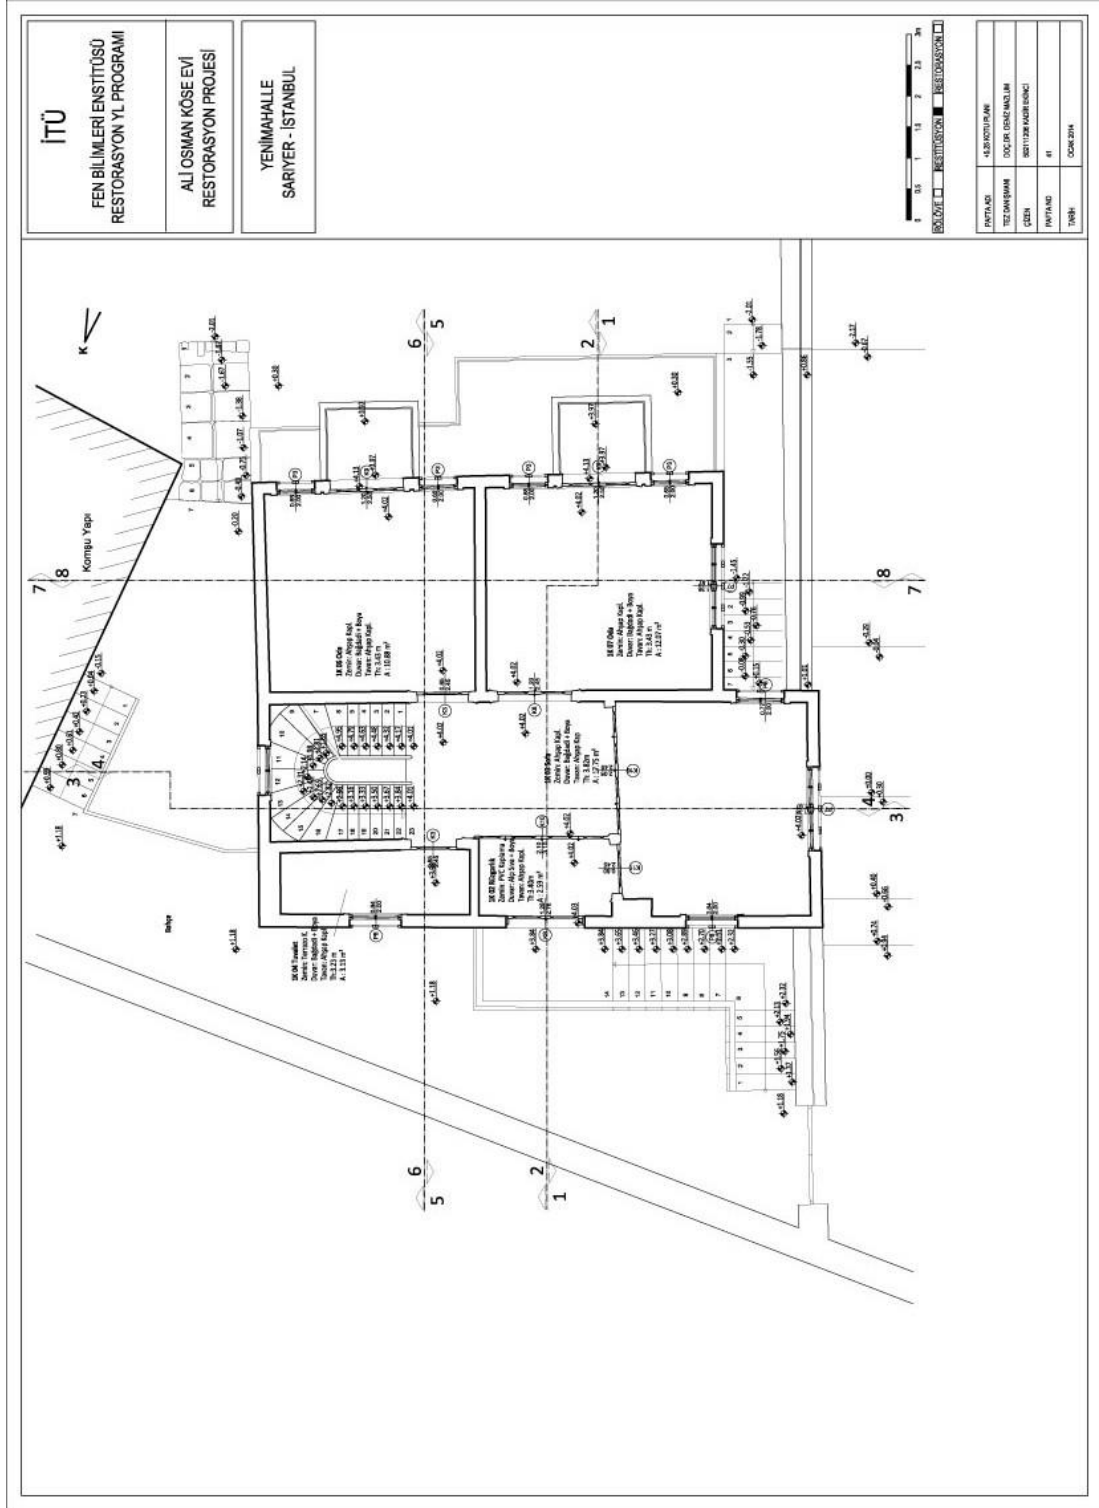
Restitüsyon – Vaziyet planı.
